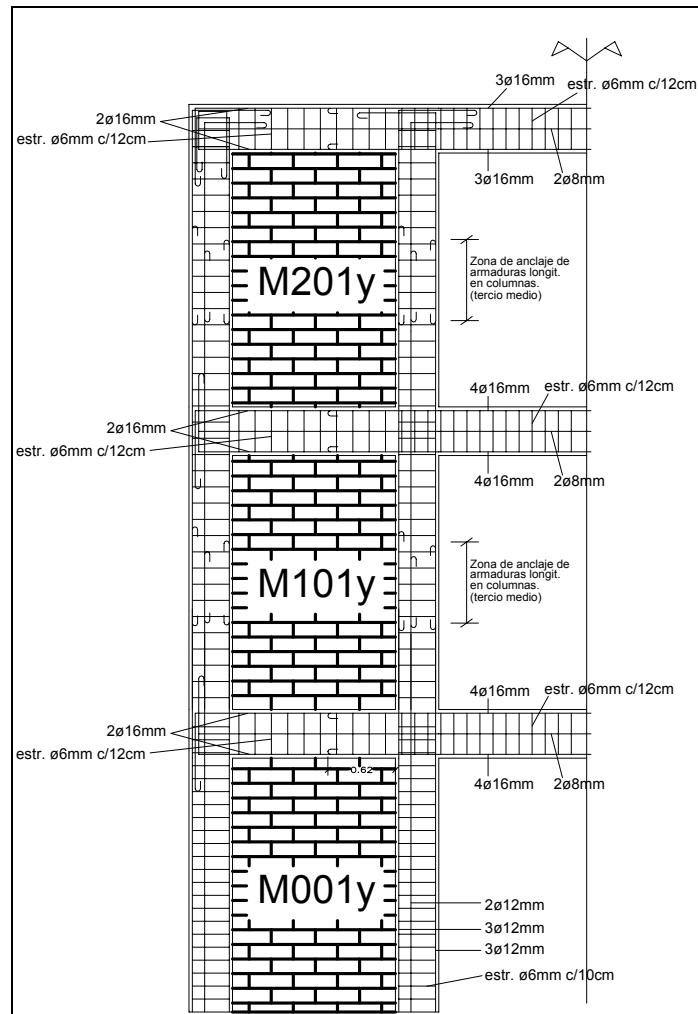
Disposiciones de armaduras en vigas de acoplamiento de muros de mampostería.
